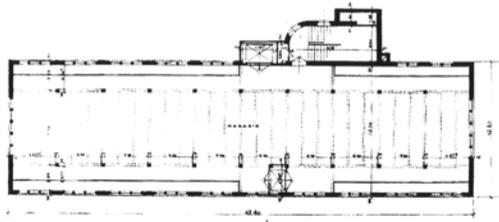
Originalgrundriss Zweiganstalt Fünfhaus
